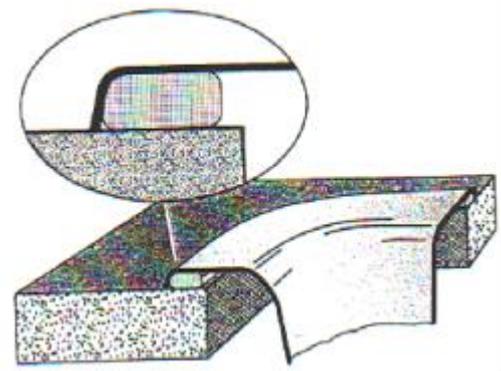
Beckeneinbau mit verdeckter Dichtungsmasse
